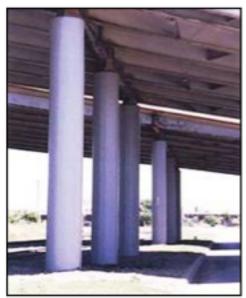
encamisado de columnas con acero. (fuente: vulka.es)
